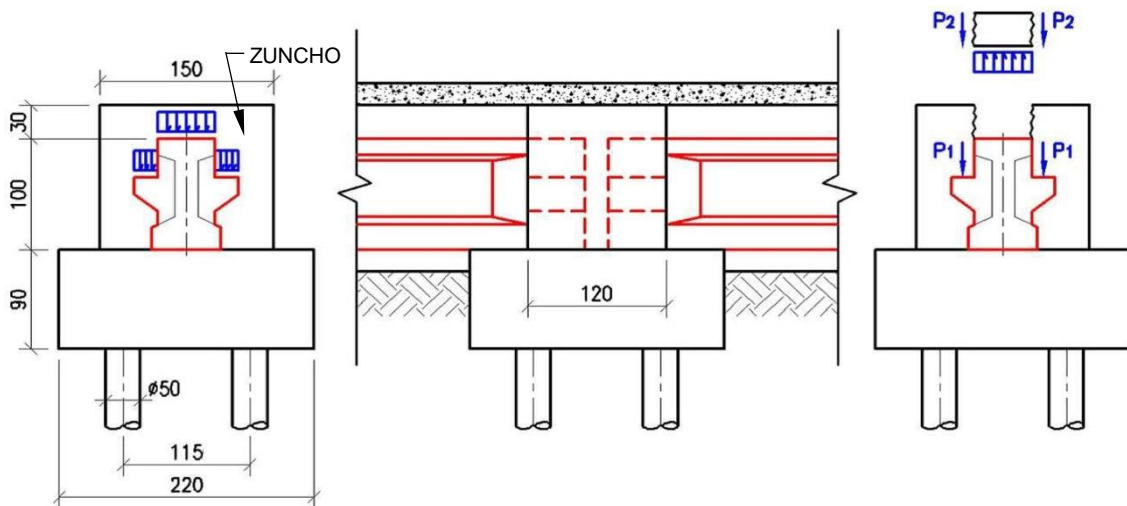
Zuncho de apoyo de vigas postesadas
